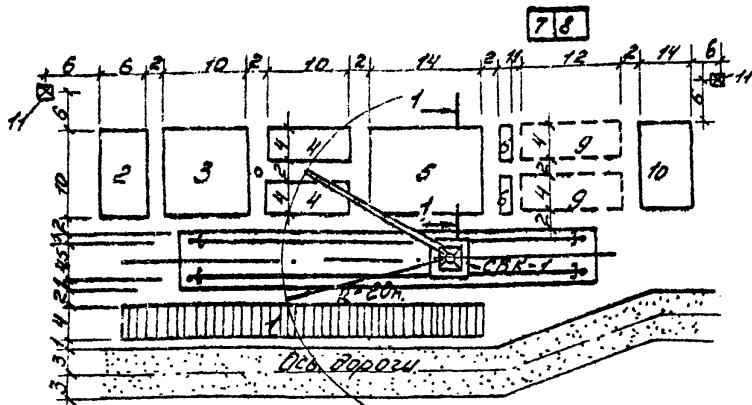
Схема сборочно-комплектовочной площадки для сборки арматурно-стапельных блоков. 1 и 10 - склад блоков; 2 - склад щитов и панелей; 3 - стена ремонтта и смазки панелей; 4 - склады панелей опалубки; 5 - стена сборки блоков; 6 - стеллажи; 7 - инструментальная кладовая; 8 - помещение для электросварочных аппаратов; 9 - склад арматуры; 11 - осветительная вышка.
